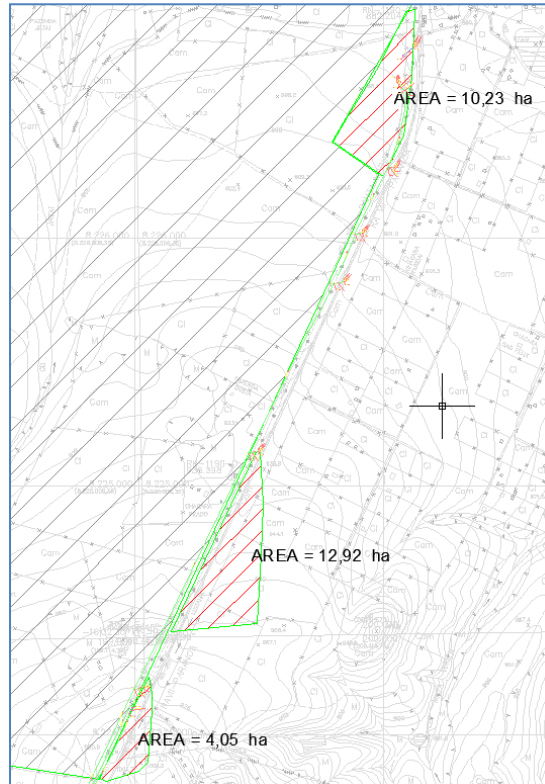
Levantamento de Bacias – Detalhes 03
